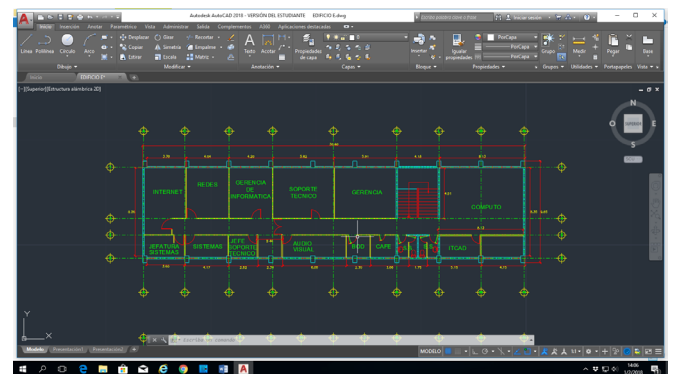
Planta Arquitectónica Edificio E realizado e AutoCad
